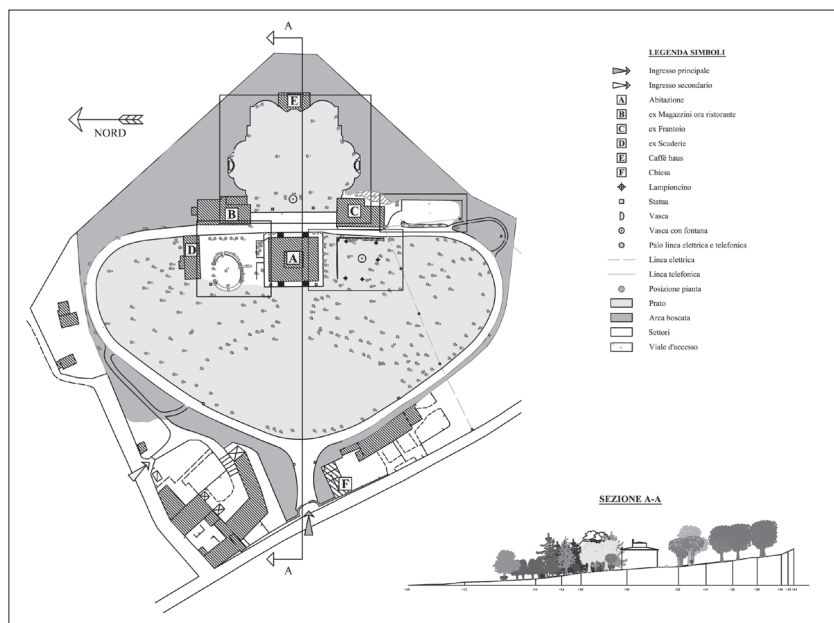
Rilievo dell'intero giardino. Planimetria generale e sezione trasversale
